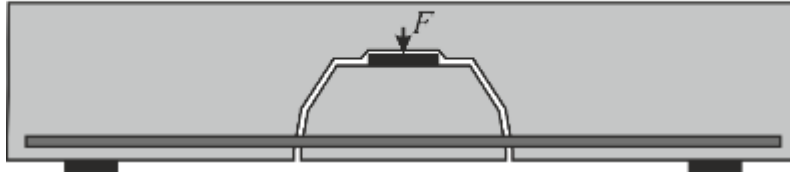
Versuchsaufbau nach *Baumann* und *Rüsch* [20] zur Bestimmung der Dübelkraft durch die Längsbewehrung für einen Balken ohne Bügelbewehrung
